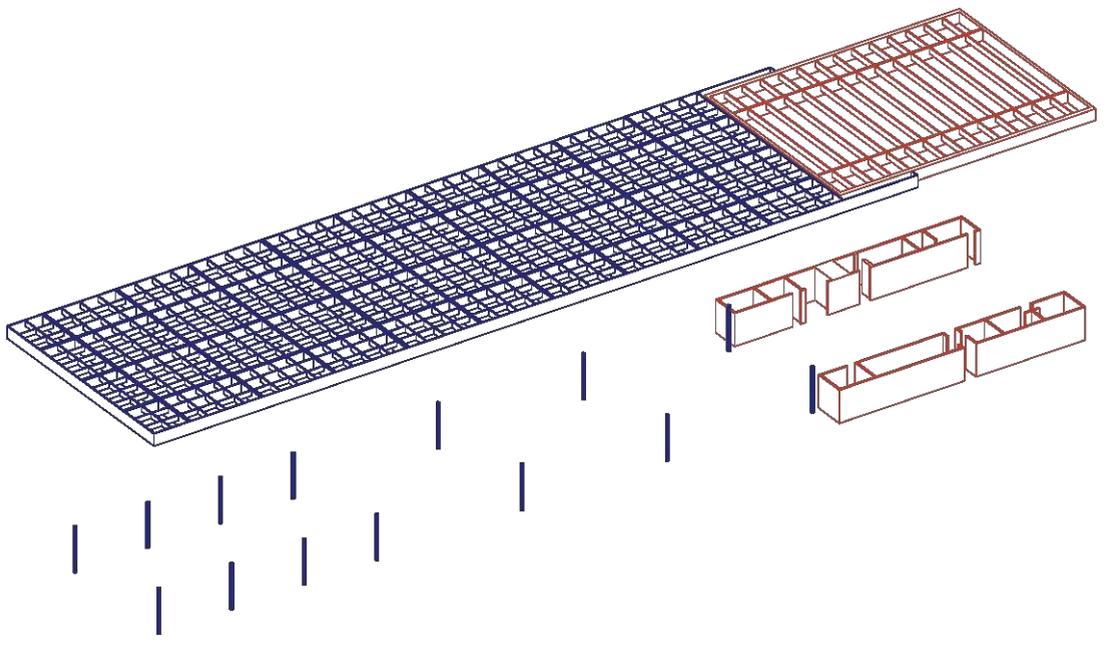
Konstruktion der Holzkassettendecke und der Stahlbetonrippendecke im Erdgeschoss
